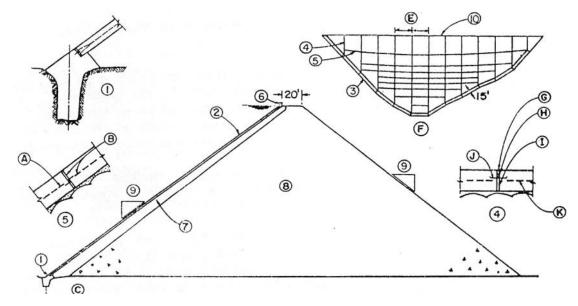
Características del proyecto tradicional de presas CFRD.
